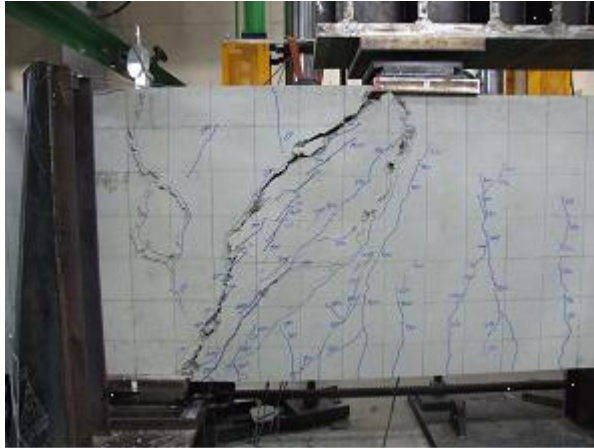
試験体 No.5 破壊状況 (最大荷重時)
